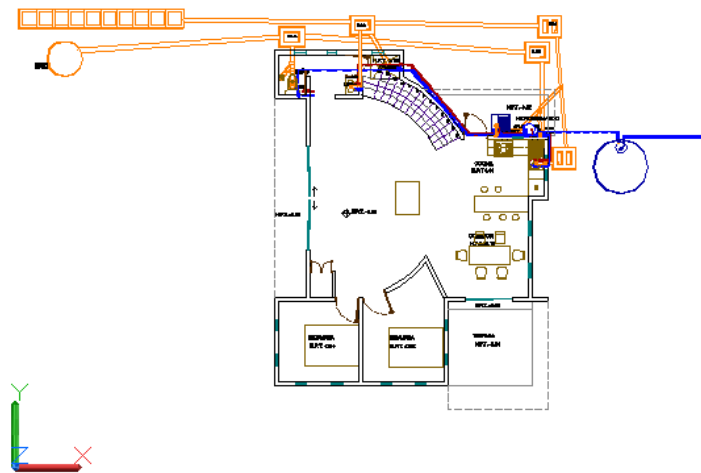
Instalación Hidrosanitaria en Planta baja
